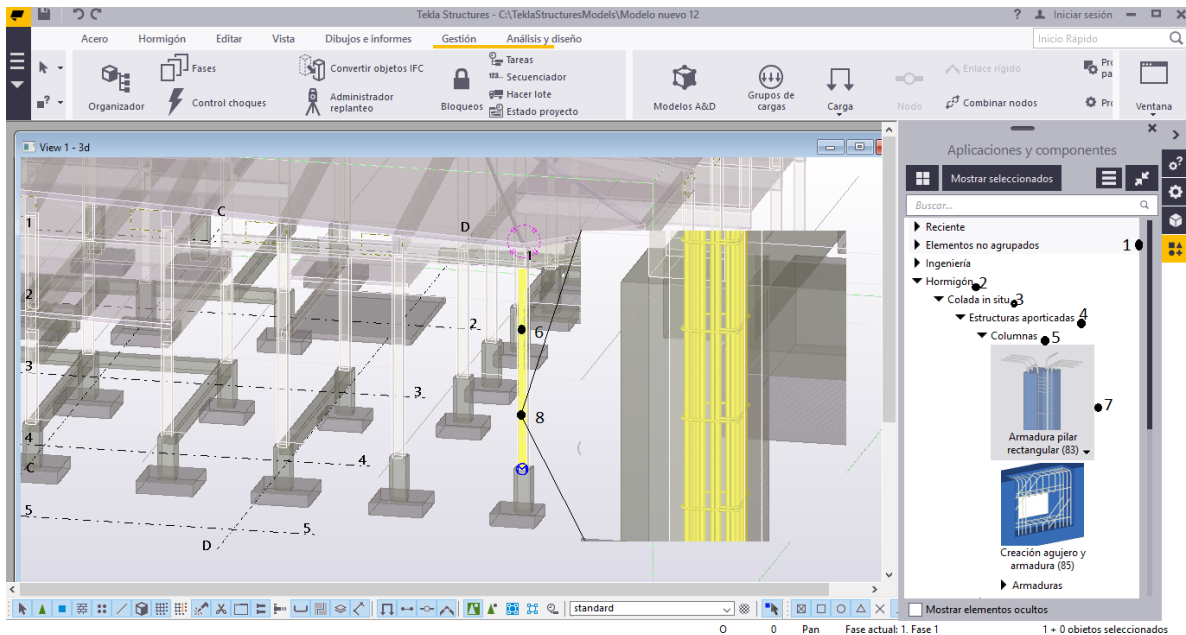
Proceso de colocación de una armadura rectangular a una columna.
